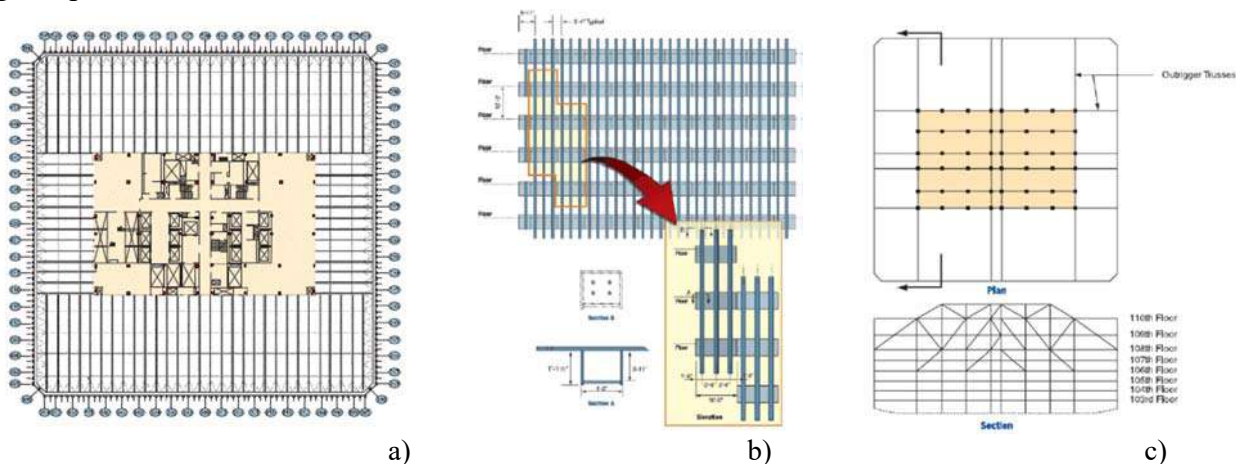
Dettagli strutturali delle torri gemelle del World Trade Center: a) planimetria che mostra il nucleo centrale e le travi reticolari dell'impalcato, b) il telaio portante perimetrale delle torri e c) la pianta e la sezione trasversale del "traliccio" in cima a ciascuna torre (FEMA, 2002)
